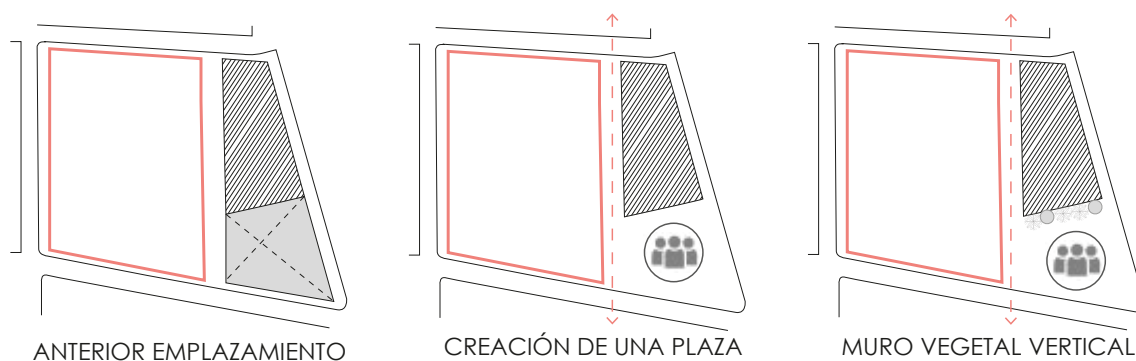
Emplazamiento CaixaForum. Elaboración: Autora
